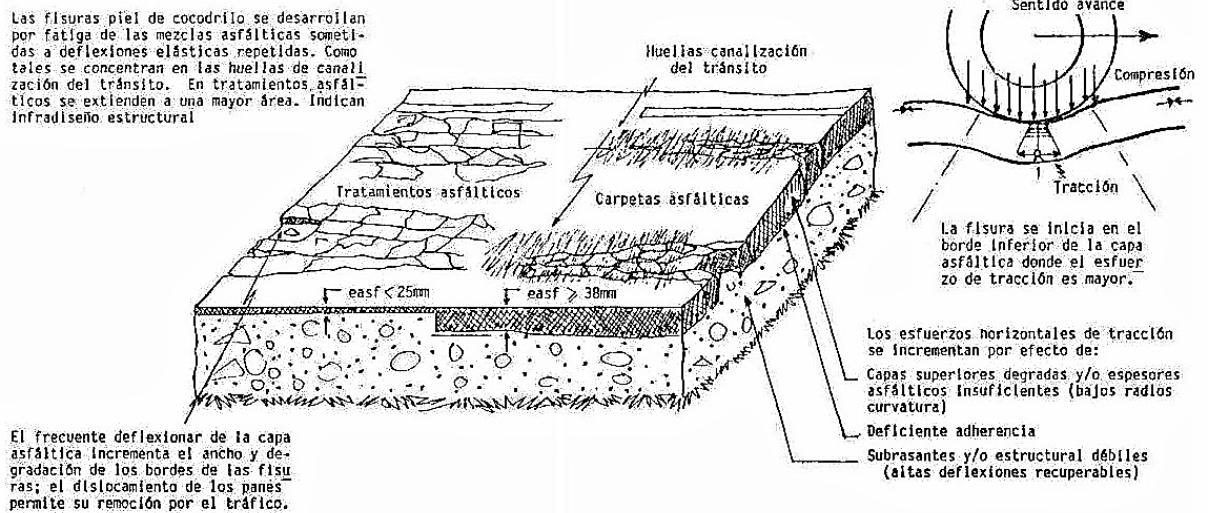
Esquema de fisuras tipo piel de cocodrilo. ⁶⁶
